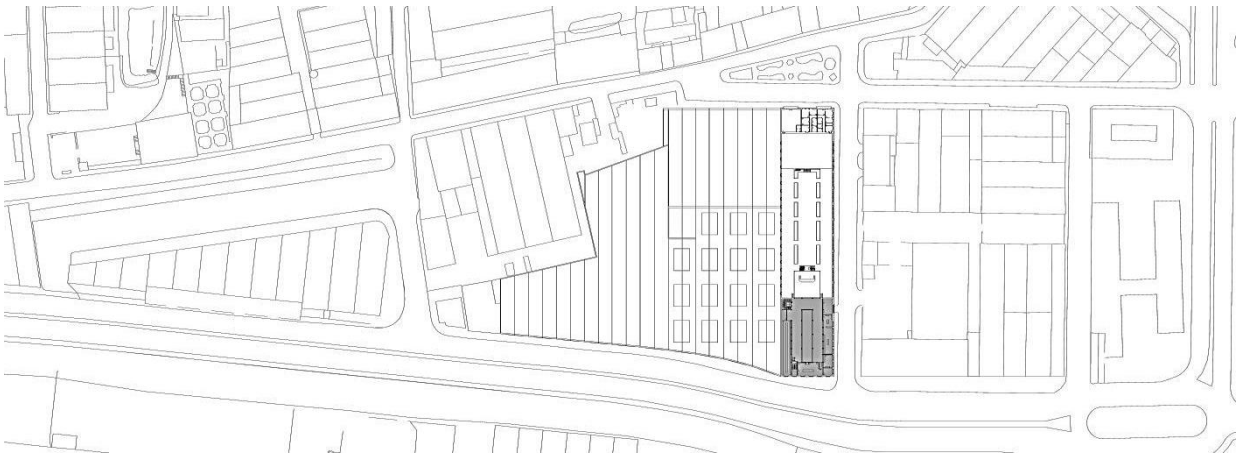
Planta de levantamento fotográfico piso 1 – Armazém 3.
